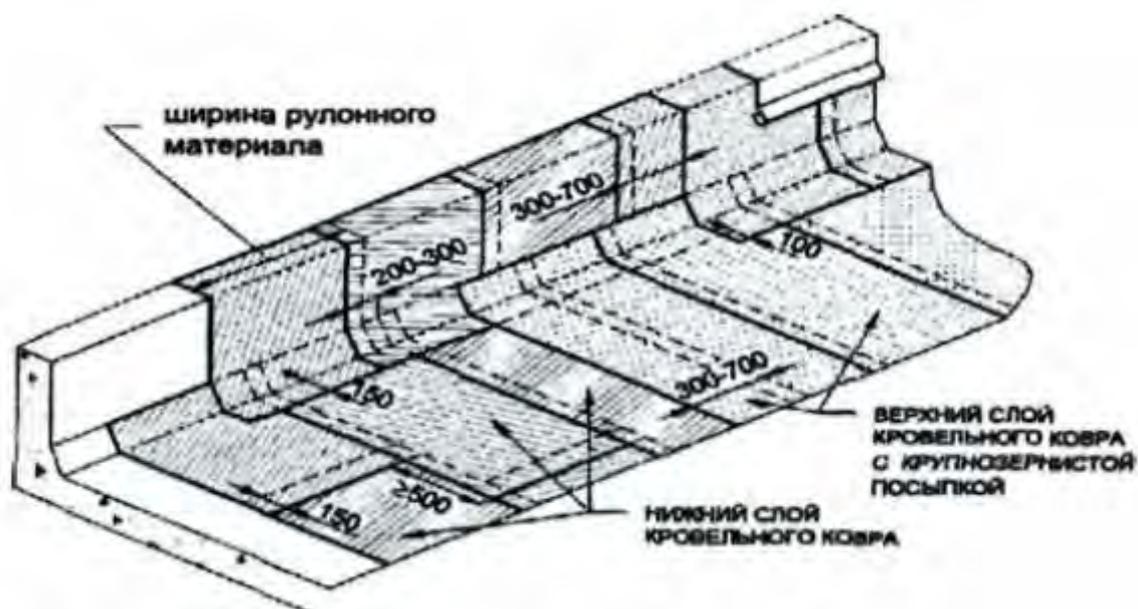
Схема раскладки полотнищ кровельного ковра (фрагмент листа 20 РМК 1104.РП)
